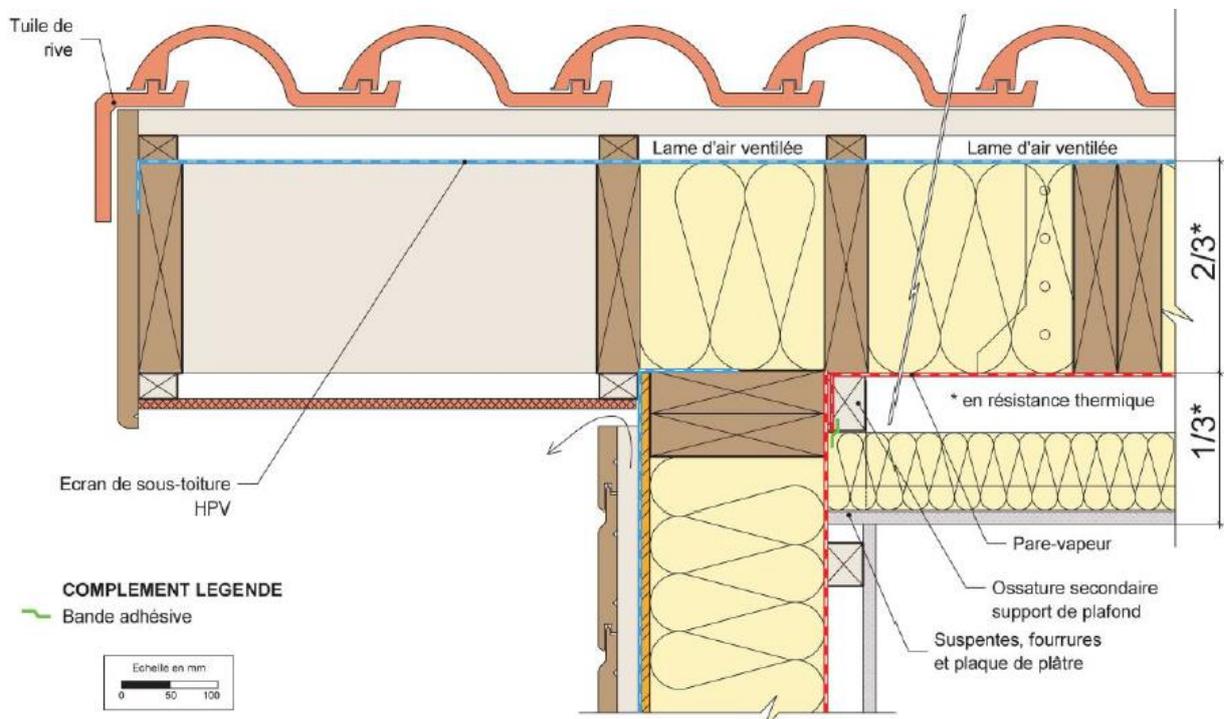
Exemple de liaison entre une toiture et un mur pignon à ossature bois avec dépassée de toiture (coupe verticale)
